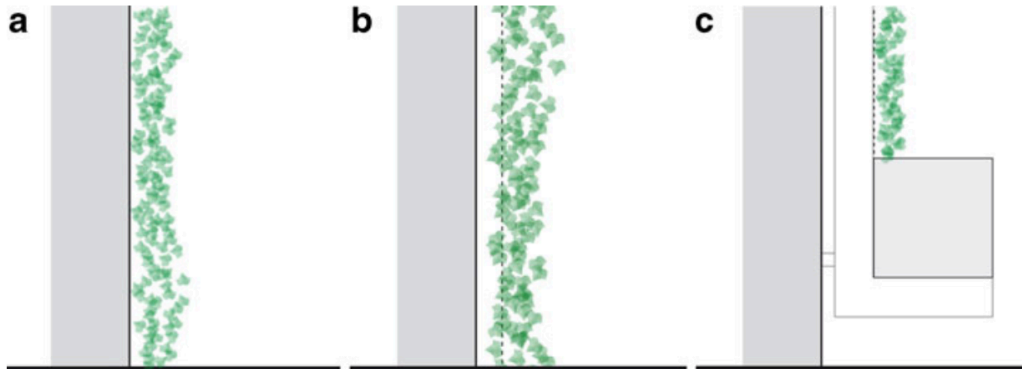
Fachada verde direta (a), fachada verde indireta (b) e fachada verde indireta combinada com caixas de plantas (c) (Perini, 2012).
